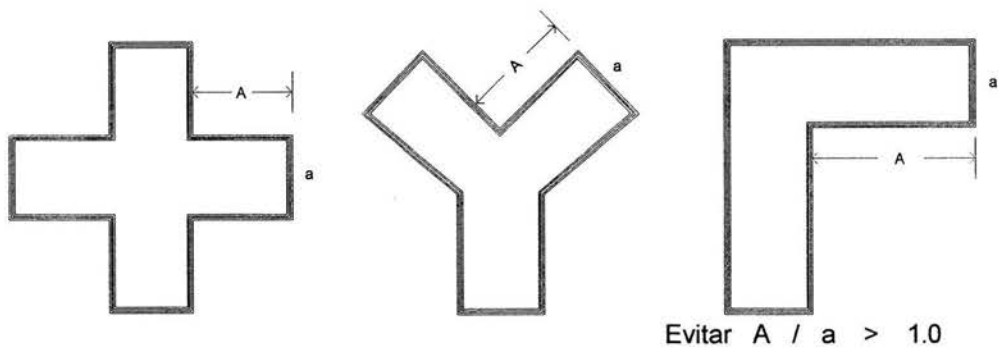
Plantas con alas largas (Meli, Bazan 1998)
